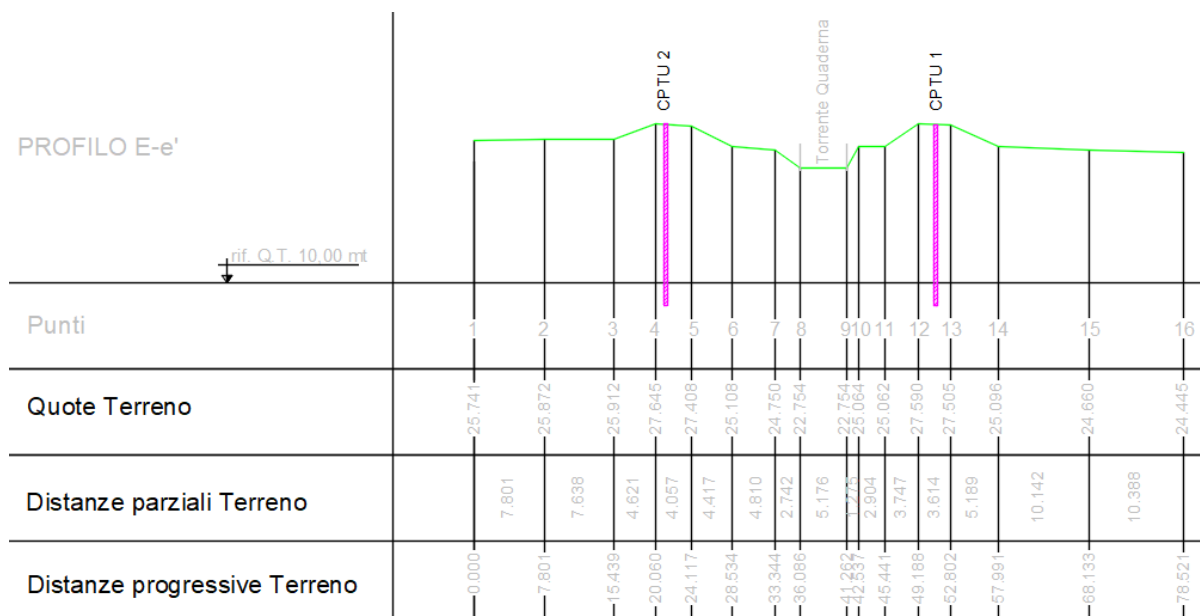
Sezione E-e di attraversamento del T. Quaderna
